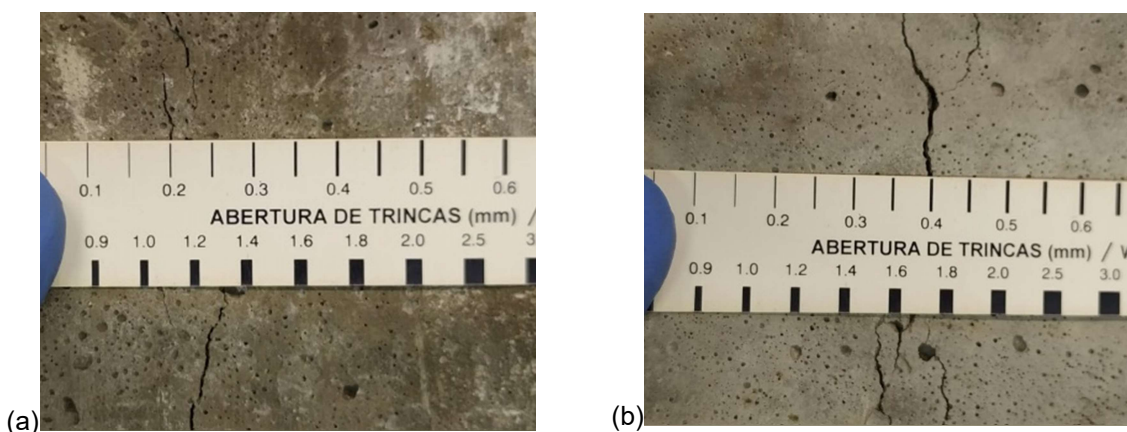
Indução de fissuras: (a) vista geral e (b) detalhe
